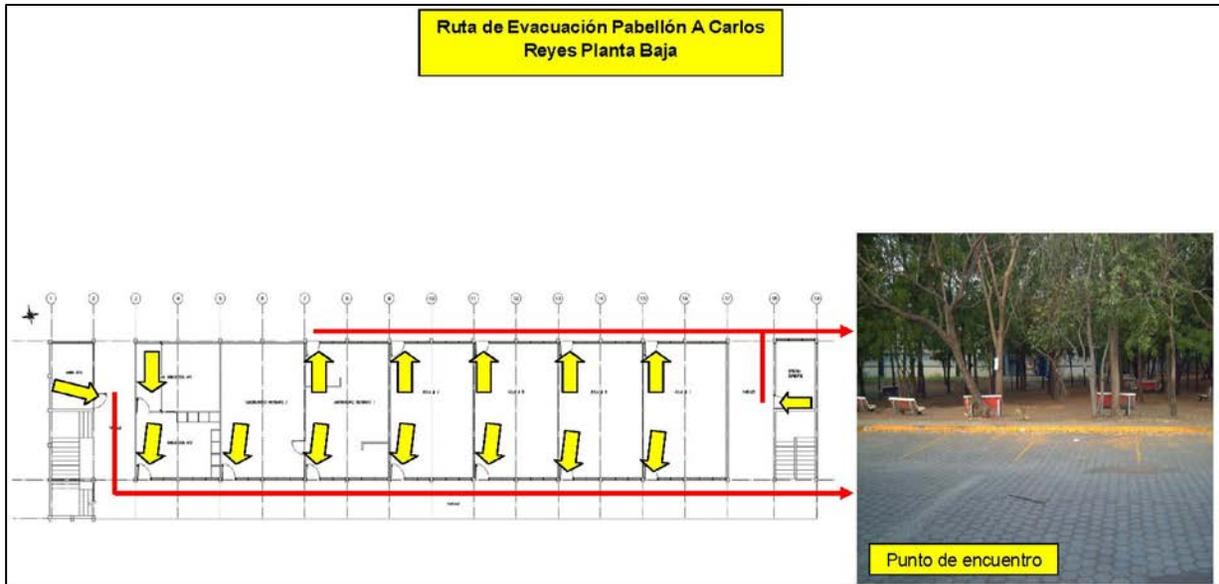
Ruta de evacuación del Pabellón “A” (Planta Baja)
